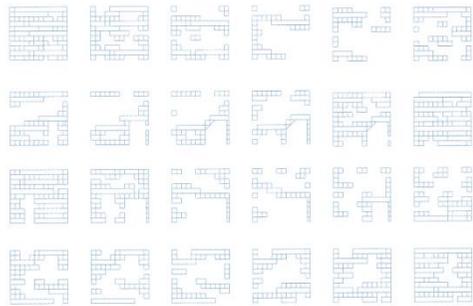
Las 24 secciones que muestran las composiciones de las vigas de madera.
